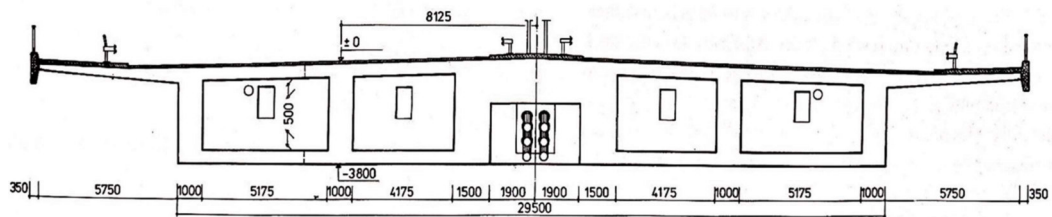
Betonová mostovka s dvěma rovinami závěsů, Posadas-Encarnación Bridge [1]
